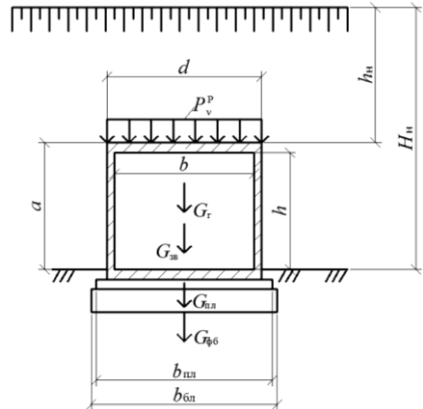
Схема к определению расчетного вертикального давления на звенья прямоугольной железобетонной трубы от постоянных нагрузок
